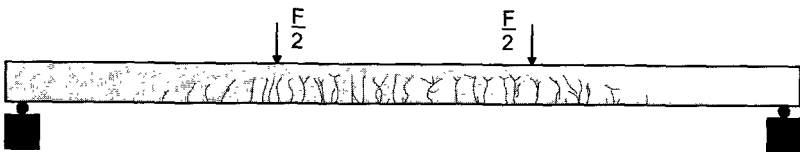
Rissbild Balken G03 nach dem Biegeversuch im Gebrauchslastbereich
